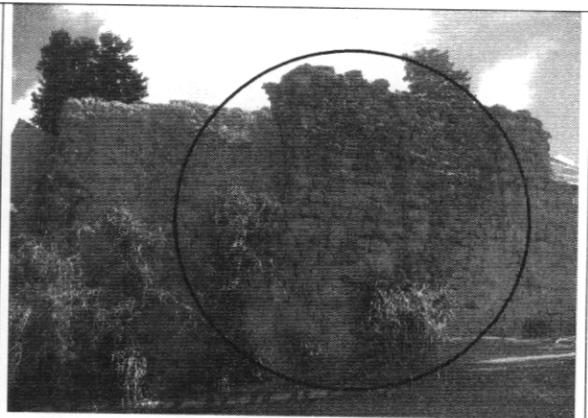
Agrietamiento y desprendimiento de unidades de mampostería
